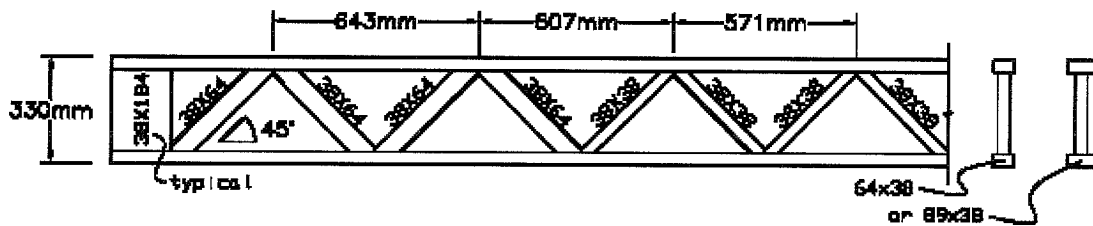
OPEN JOIST 2000 – HAUTEUR 330 mm
